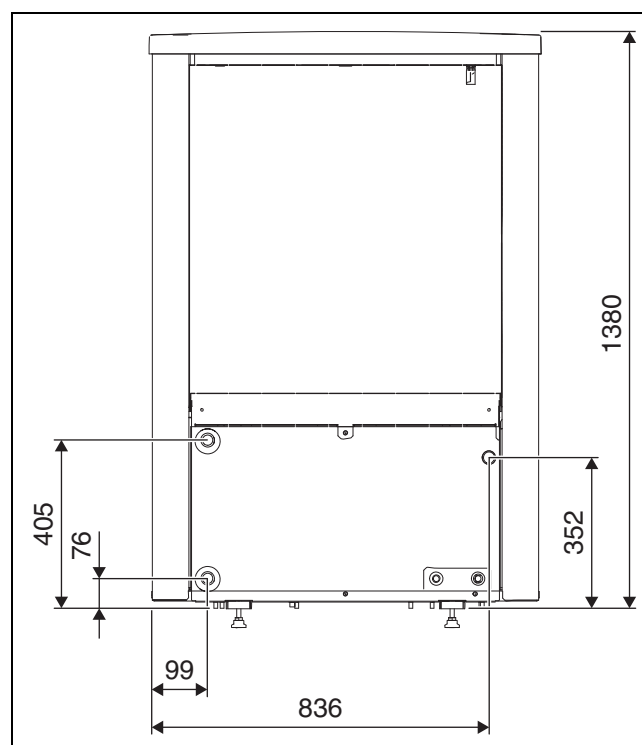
Dimensions et raccords des modèles de pompe à chaleur ODU4.2i S+ - ODU6.2i S+, partie arrière
